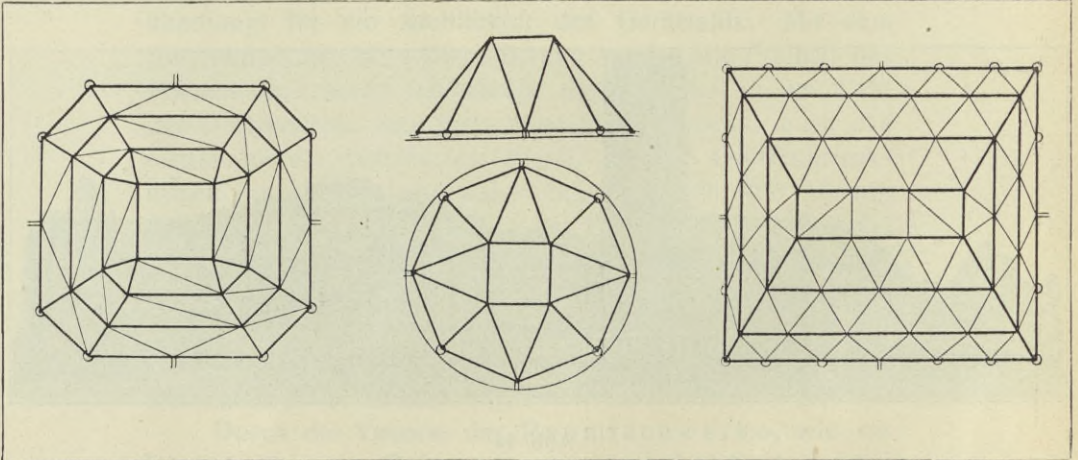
(Zeichnungen von Prof. Dr. W. Schlink-Braunschweig; wiedergegeben in „Der Industriebau“, 1910, Heft 2, Abhandlung „Neue Kuppel- und Dachsysteme“, Verlag Carl Scholze-Leipzig)
